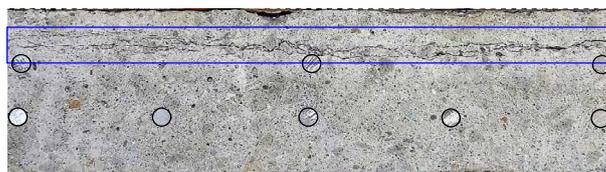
凍結融解試験で再現された水平ひび割れ³⁾
